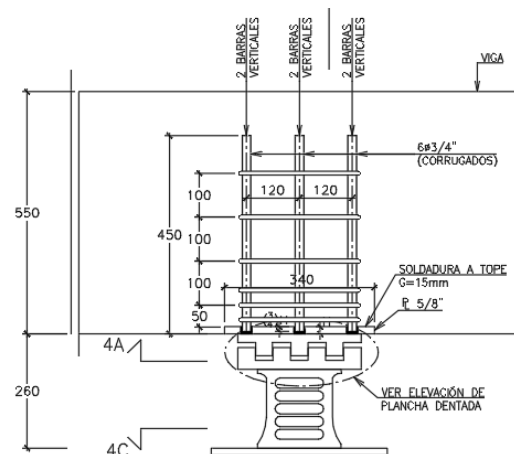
19. Armado de conexión dispositivo SLB y viga prefabricada
